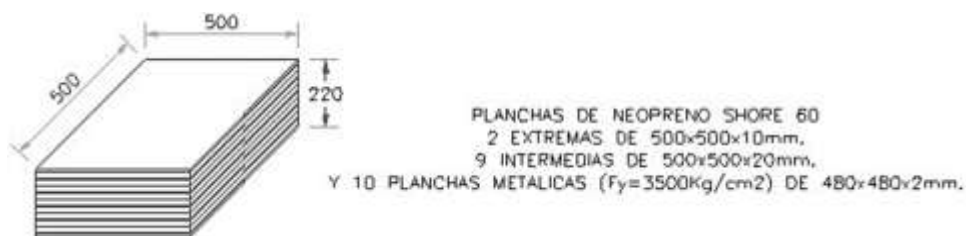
Detalle típico de apoyos elastoméricos en pilares.
